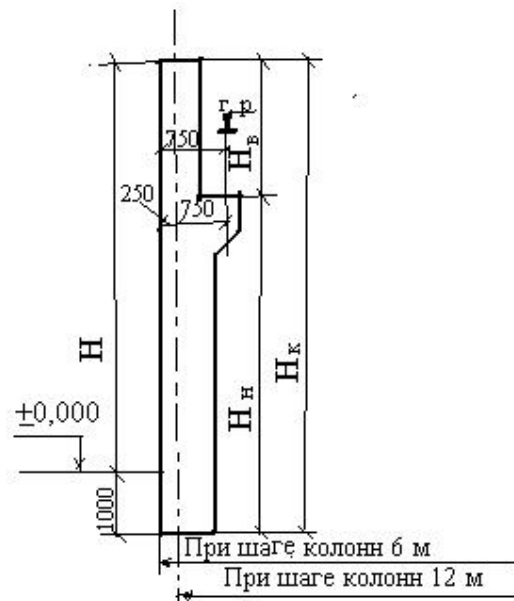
Крайняя колонна прямоугольного сечения для зданий с мостовым краном
